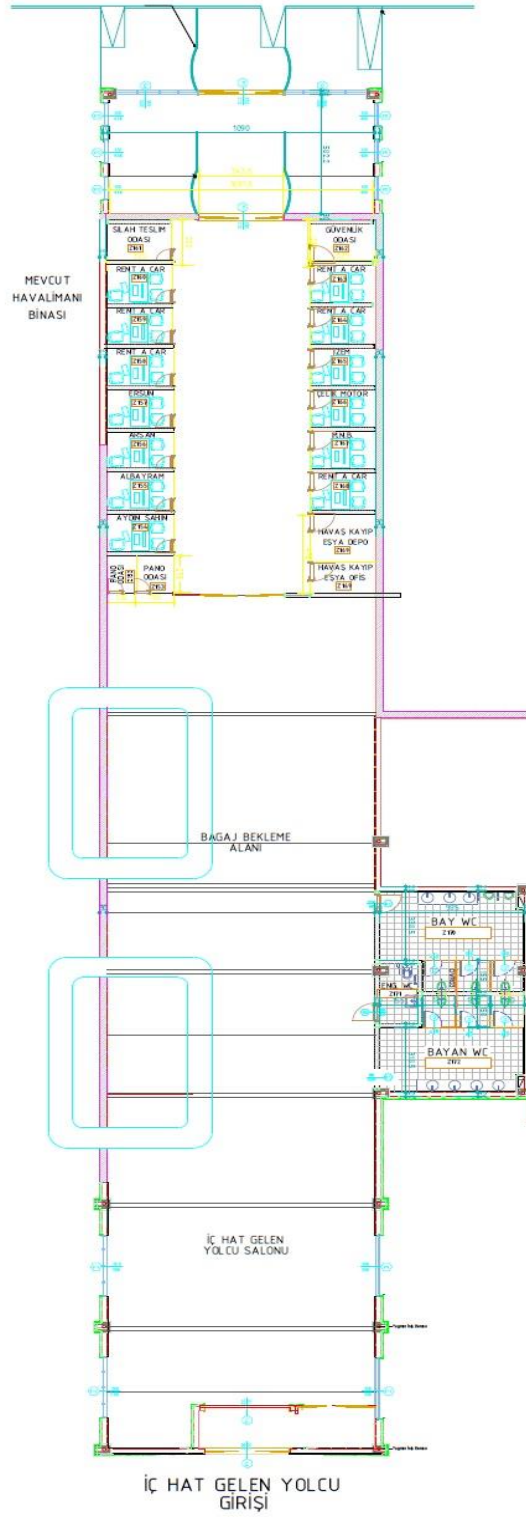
Mevcut terminal binası asma kat planı.
